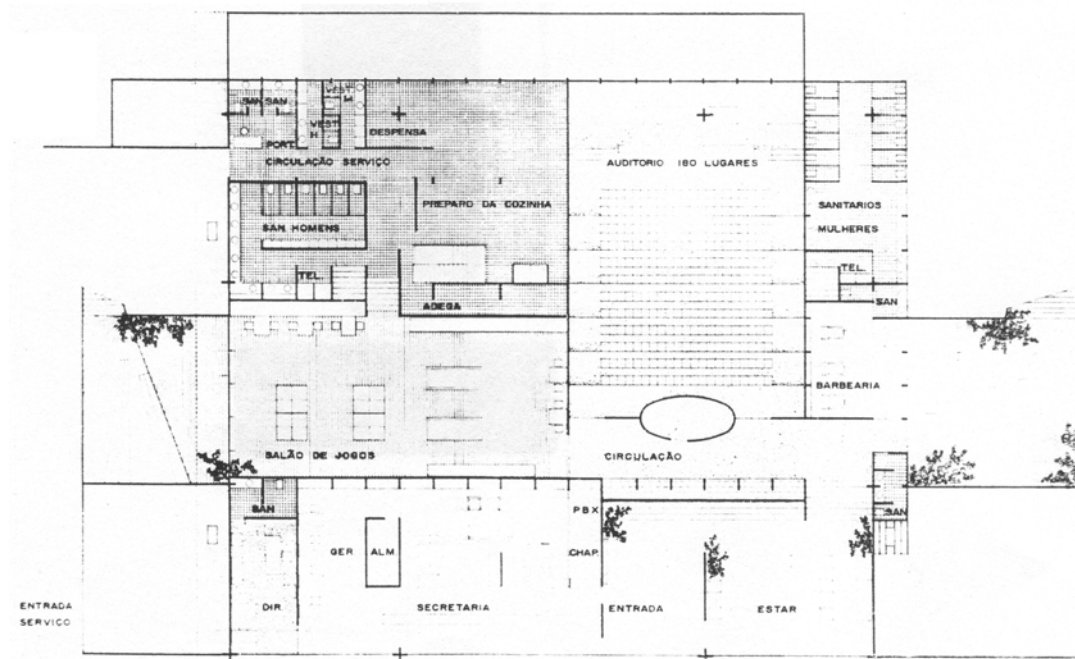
Planta piso inferior - Fonte: ACRÓPOLE, 340 jun., 1967, p. 31.
